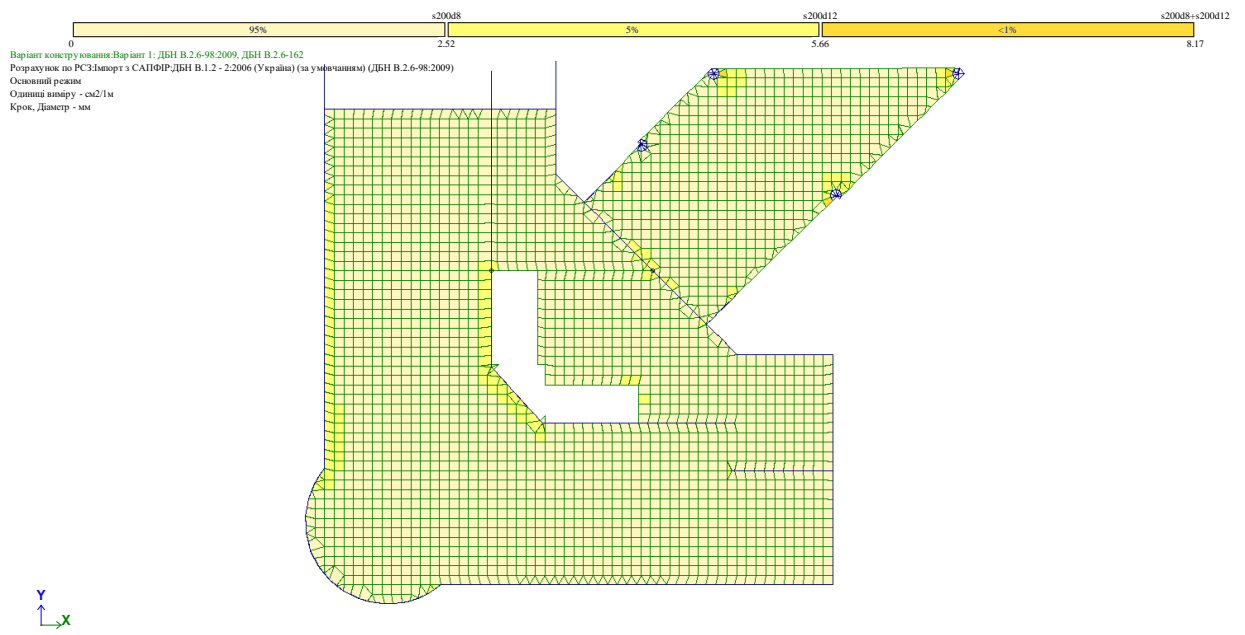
Площа повної арматури на 1мм уздовж осі X біля верхній грані для плити перекриття 1-го поверху
